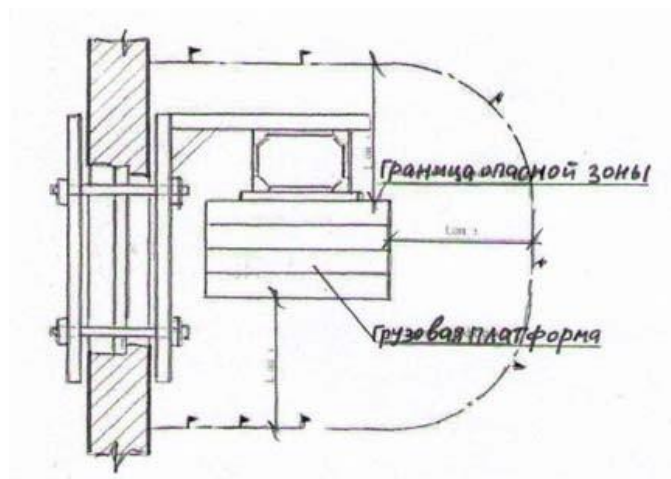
Опасная зона при работе грузового строительного подъемника
